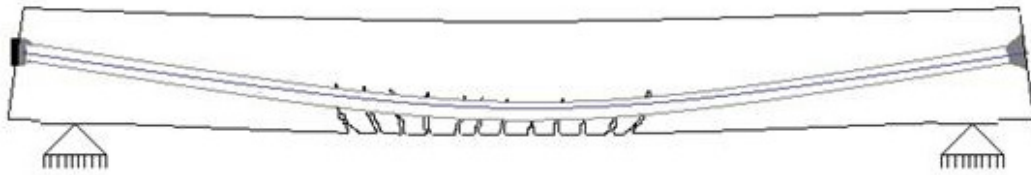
Fallas en una viga Preesforzada Grietas
